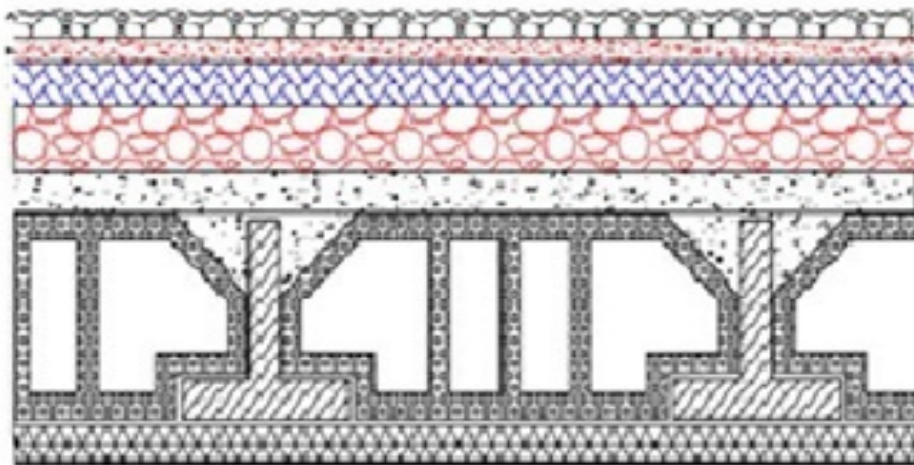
Détail de plancher corps creux terrasse inaccessible.
